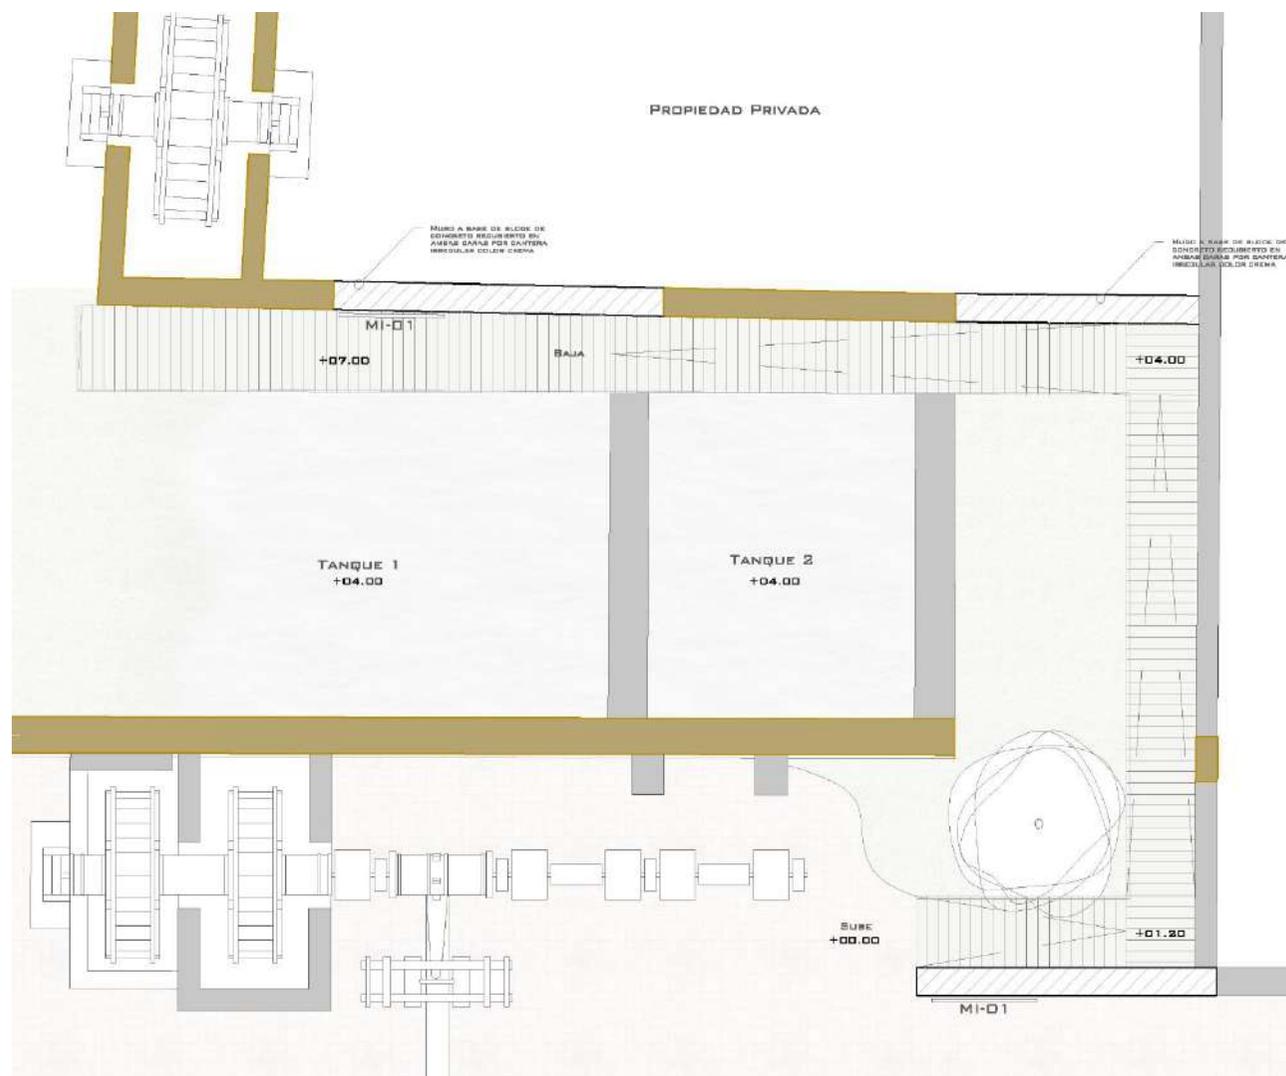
Planta Baja de zona de protección, en amarillo y gris se identifican los muros originales.
